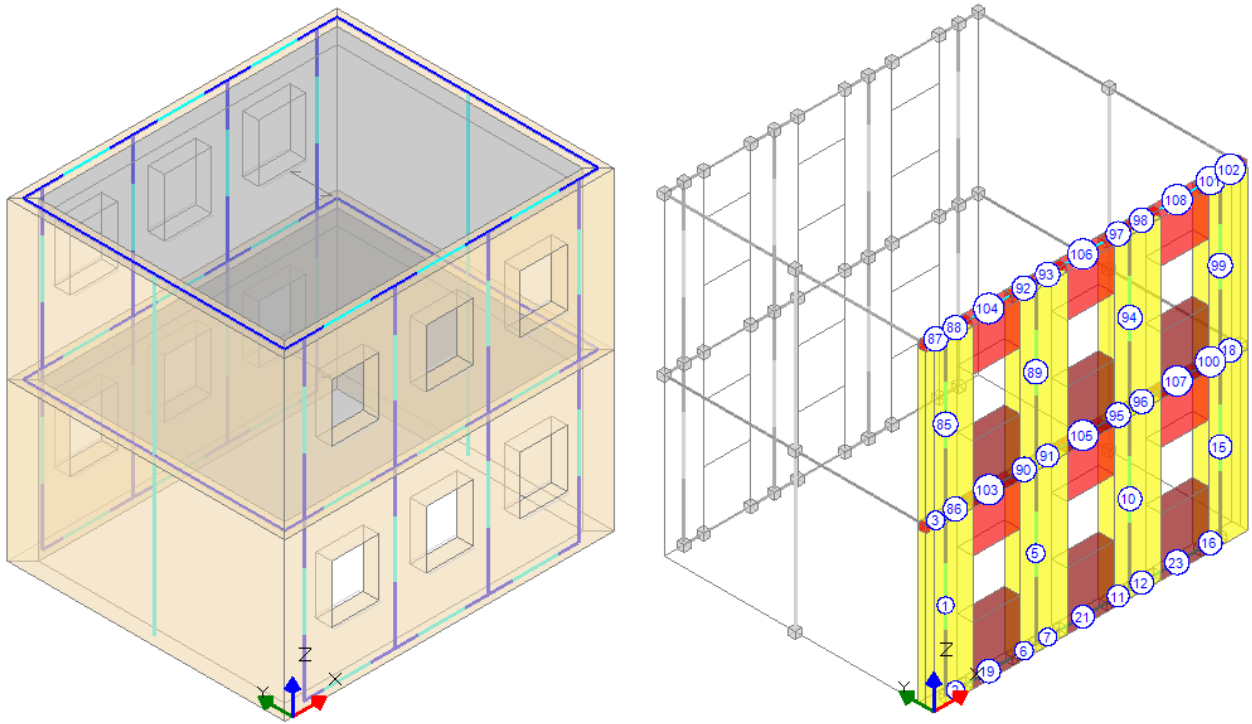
Parete C: modellazione architettonica e strutturale
